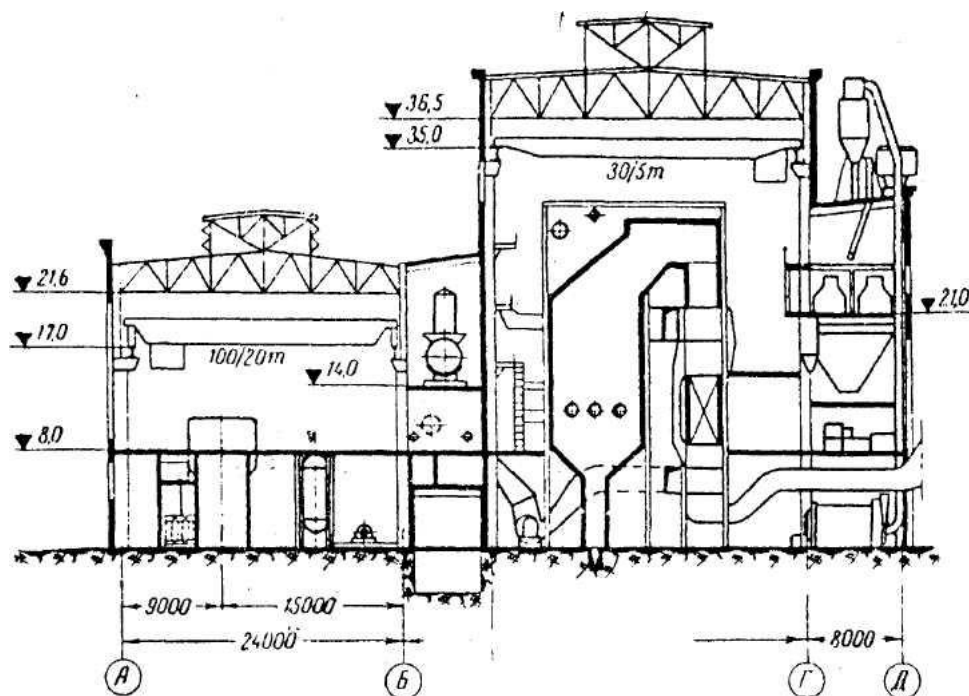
Компоновка главного корпуса с наружной бункерной этажеркой (поперечный разрез)
